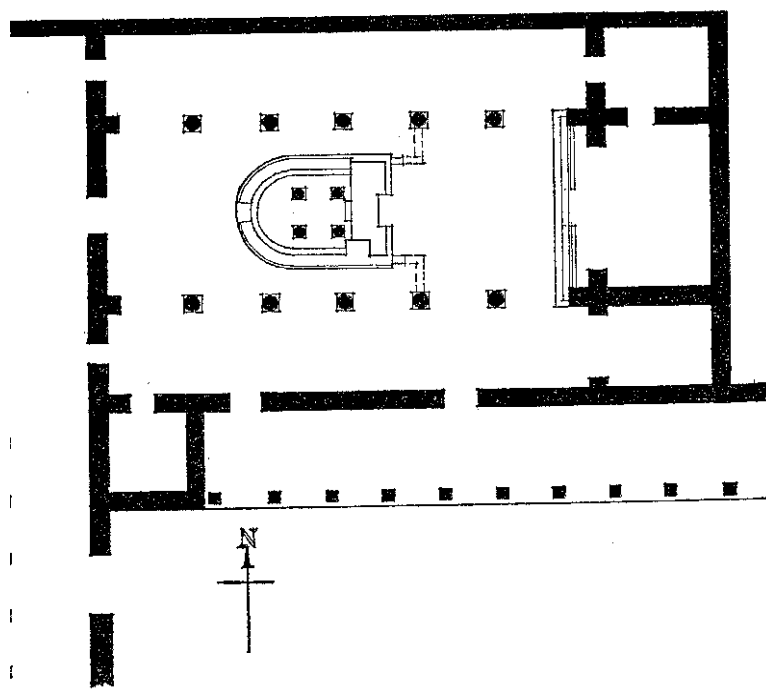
Planta baixa da igreja de Behyo, Síria.
